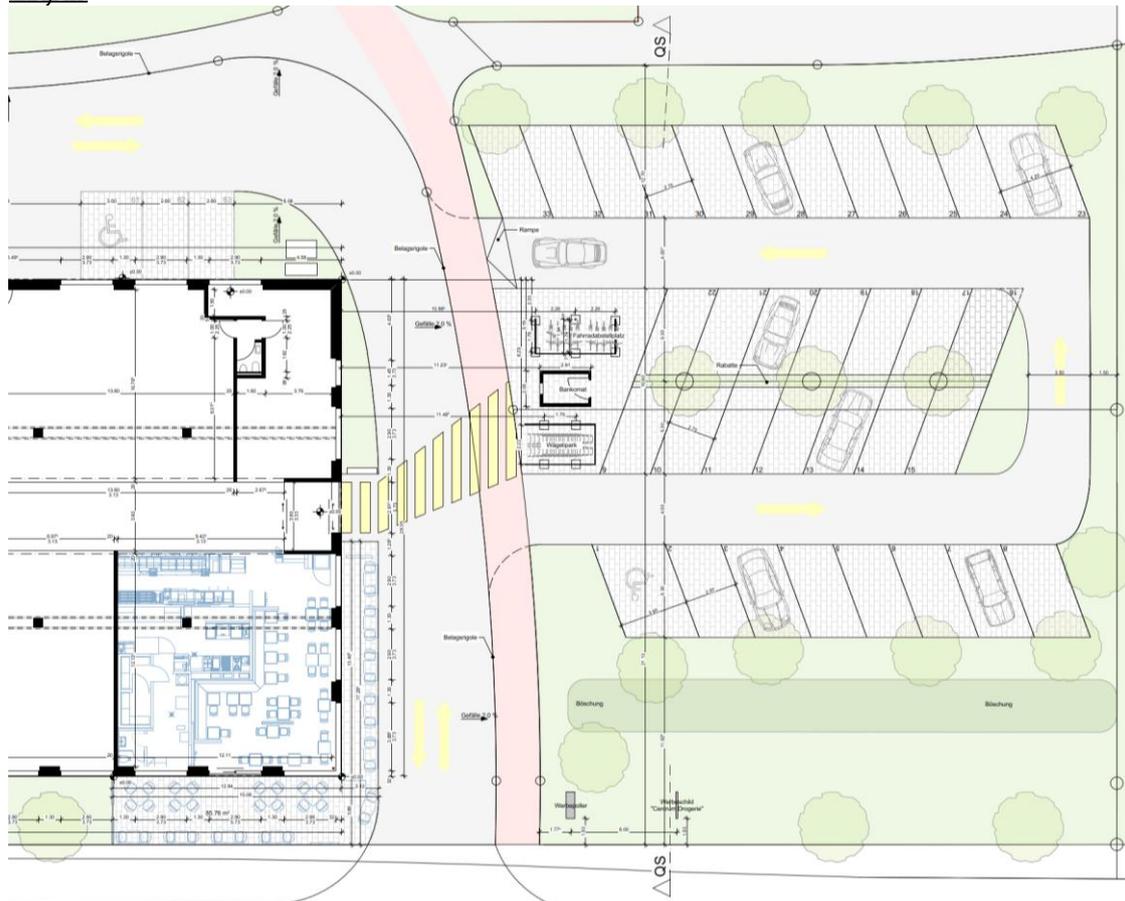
Umgebungsplan Projekt Essane Center (Stand: 07.09.2023)
